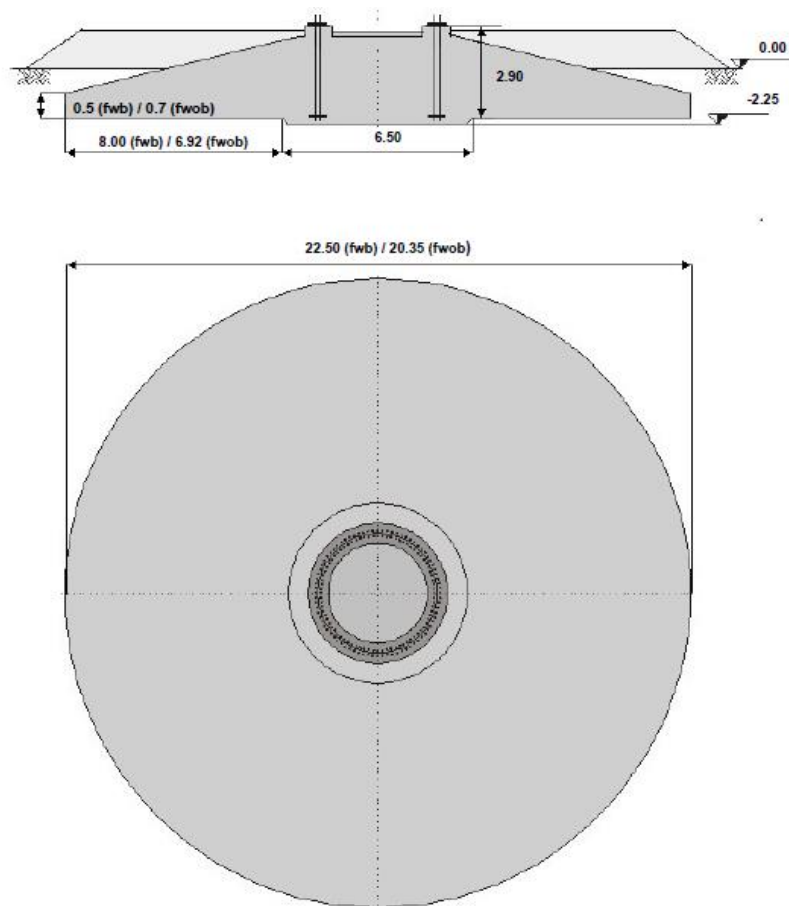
Plans schématique des fondations de l'éolienne N131 – 3,6MW - 165m (Source : NORDEX)
